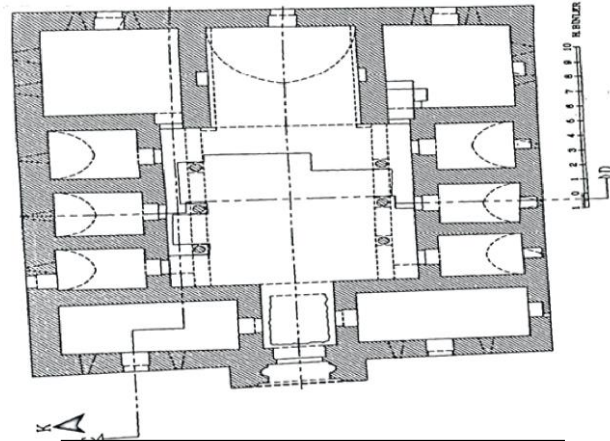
مسقط أفقي لجامع يولي منارة في أنطاليا
